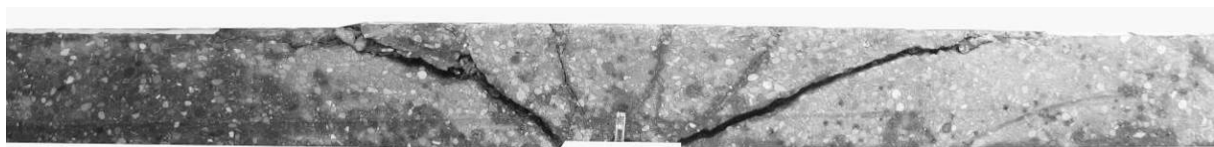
Fissuration à plusieurs niveaux de charge et fissures internes de la dalle B2-01.
